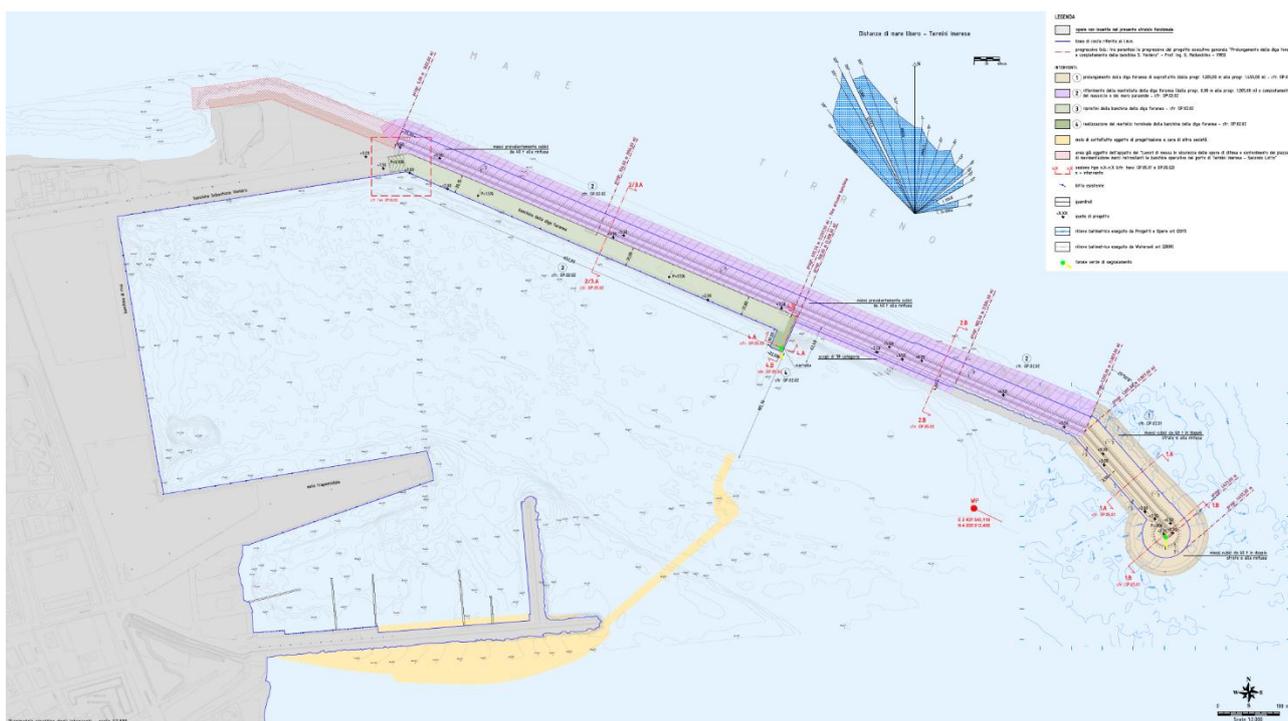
Stralcio della Tavola OP.01 del Progetto Definitivo: Planimetria sinottica delle opere in progetto
